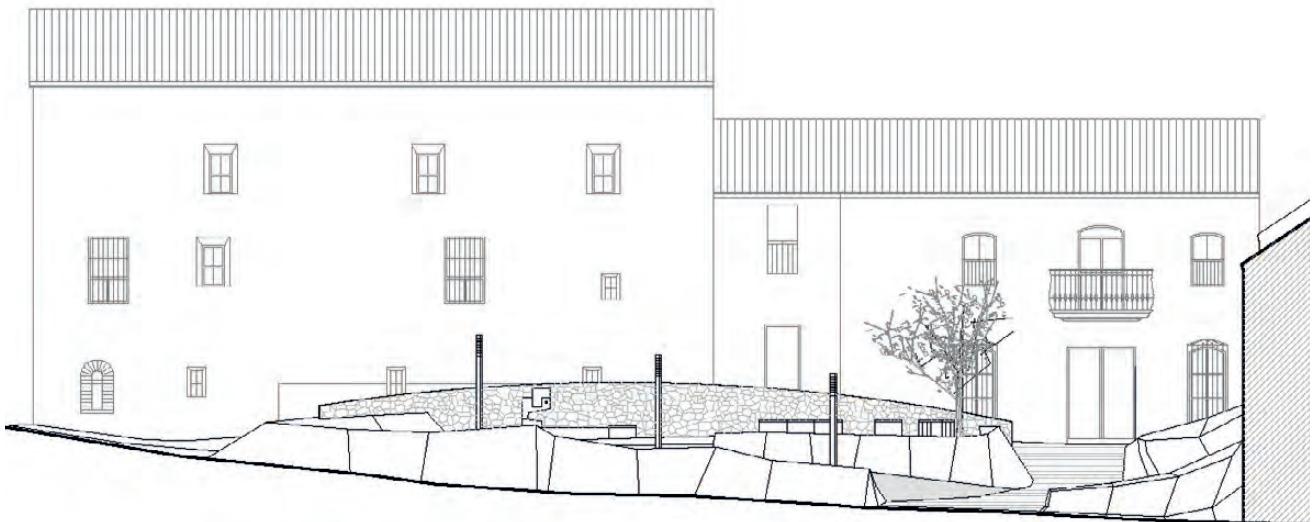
Alzado de la propuesta. Imagen de los autores (2000) / Figure 7. Elevation – longitudinal section (2000).
